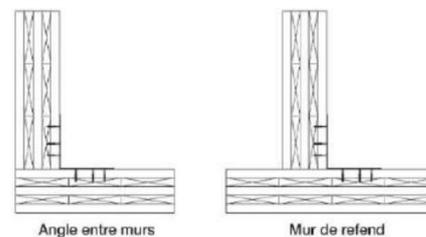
Assemblage entre murs par connecteurs tridimensionnels
